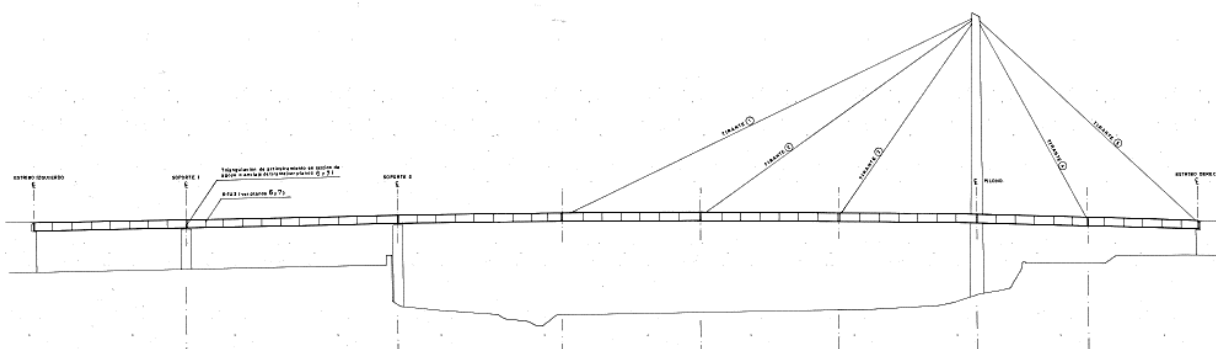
Esquema del alzado de la pasarela. (Fuente: Proyecto modificado de construcción).
